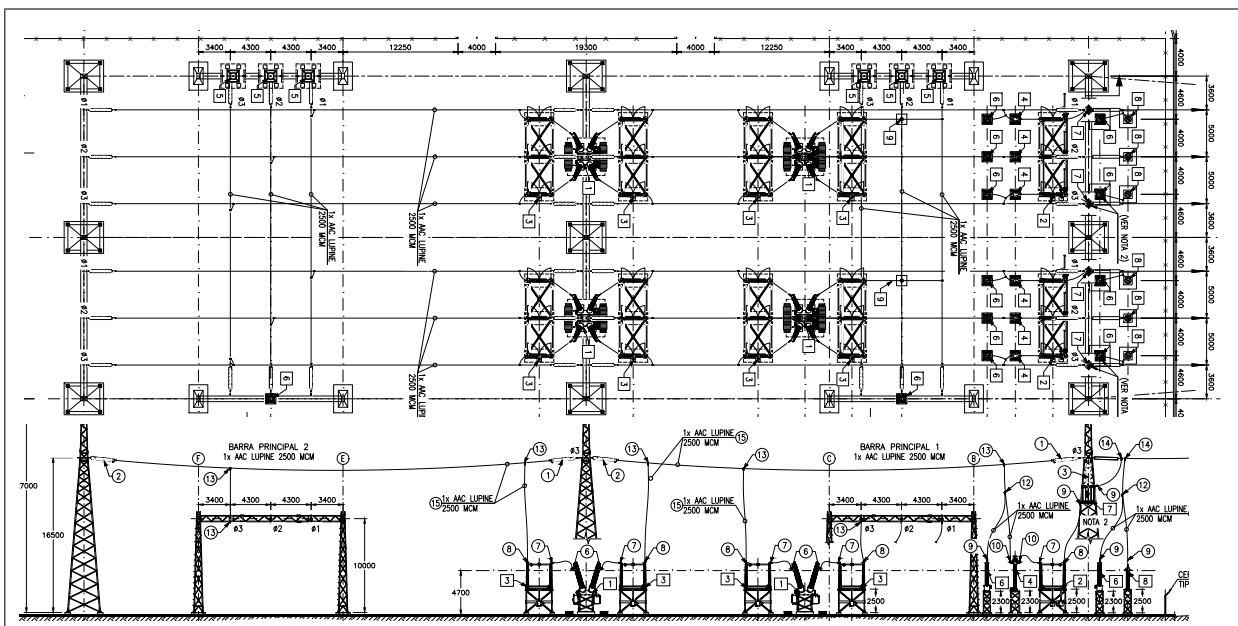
Plano en planta y elevación ejemplo seccionadora interruptor y medio. [2].
